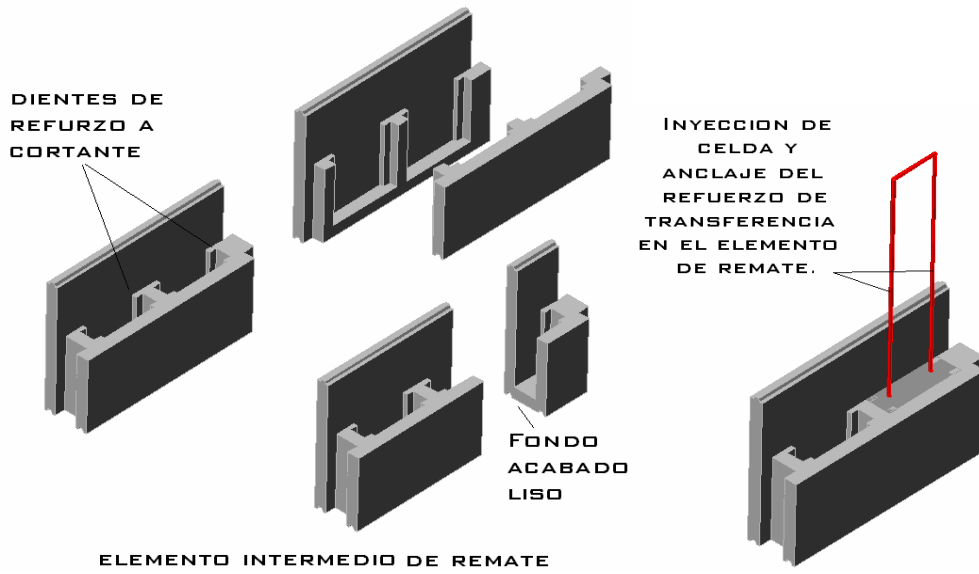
DETALLE ELEMENTO DE REMATE UNIÓN MURO DIAFRAGMA
